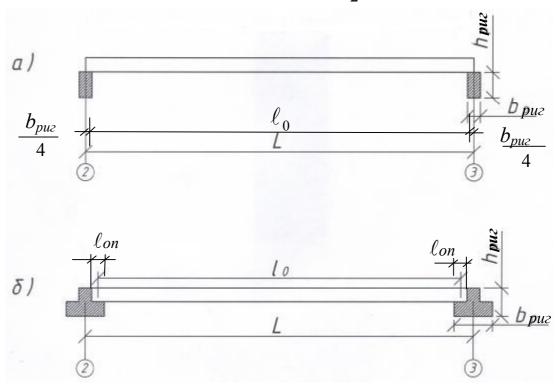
Схема опирания плиты а) на прямоугольный ригель; б) на тавровый ригель
